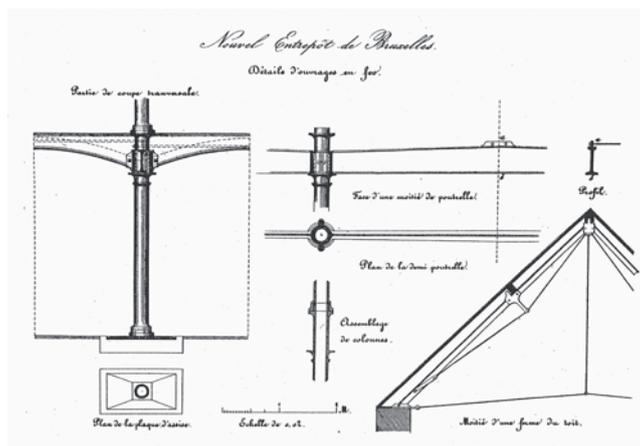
Plan de 1843 avec des détails de construction de la ferronnerie pour l'Entrepôt royal qui renvoient à la construction anglaise fireproof mill typique [2].
